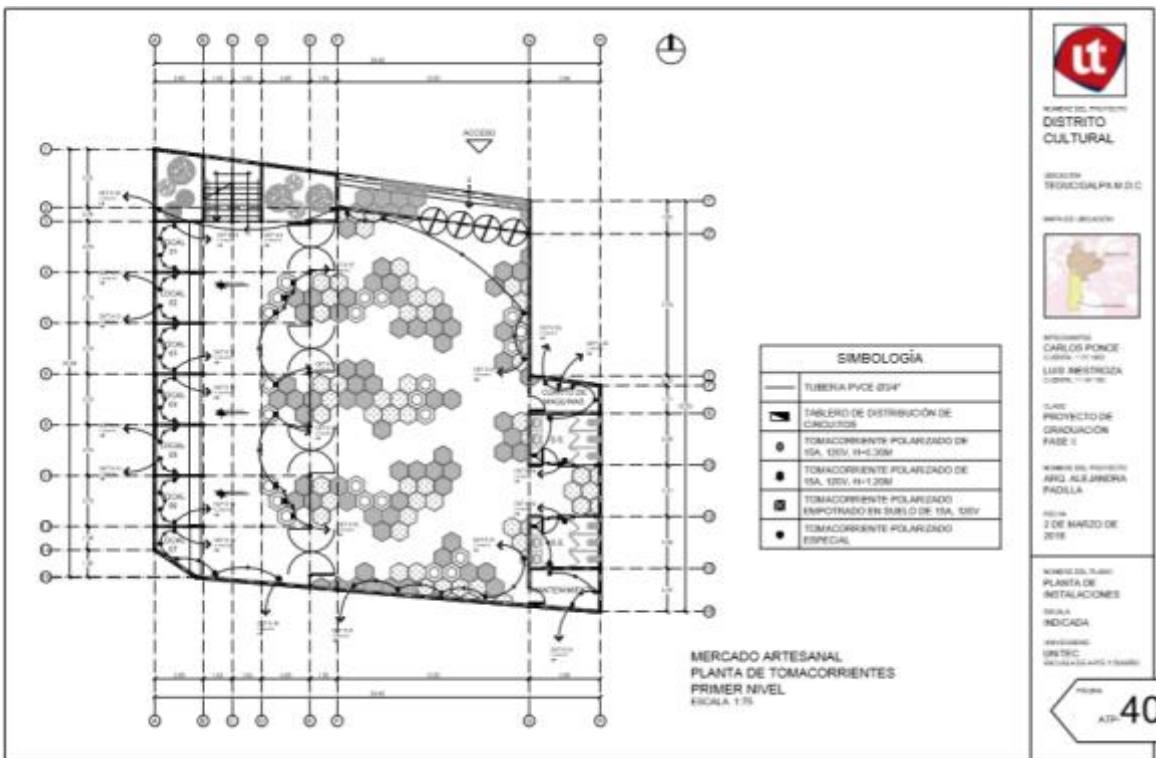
Planta de Tomacorrientes Mercado Artesanal Primer Nivel
